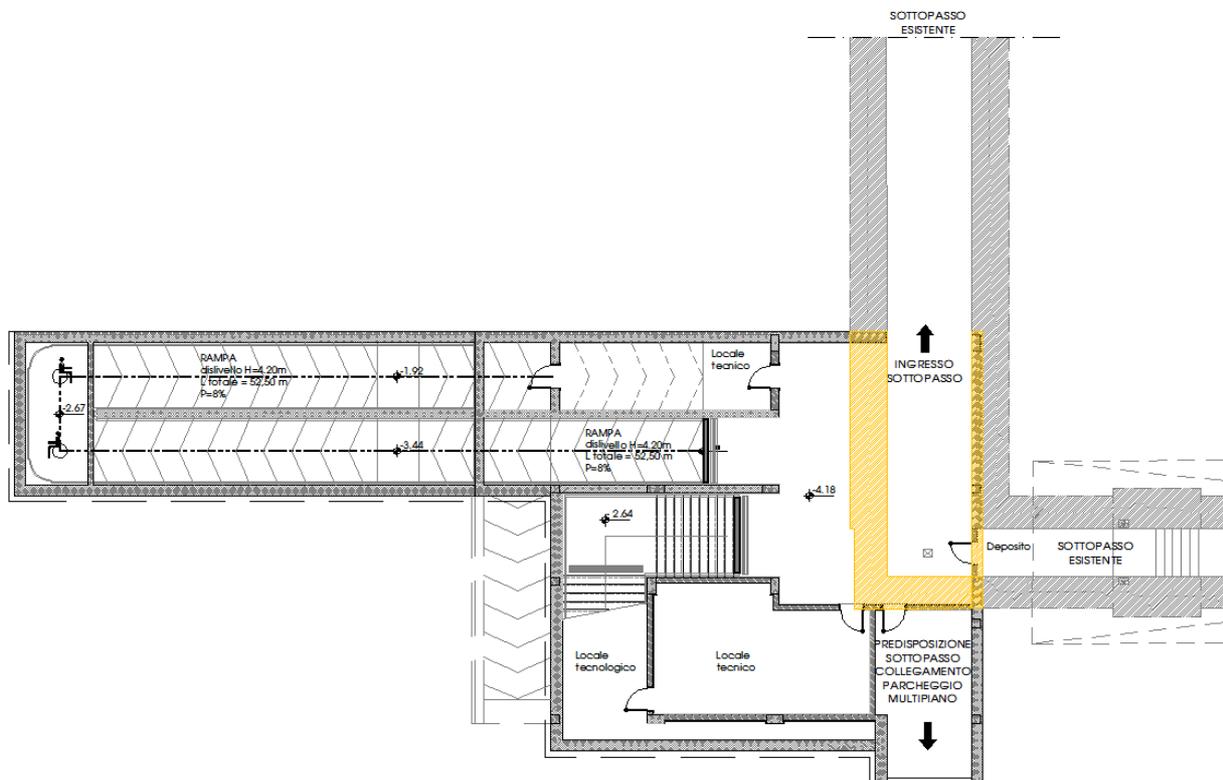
Stazione di Barletta Centrale: pianta livello interrato
